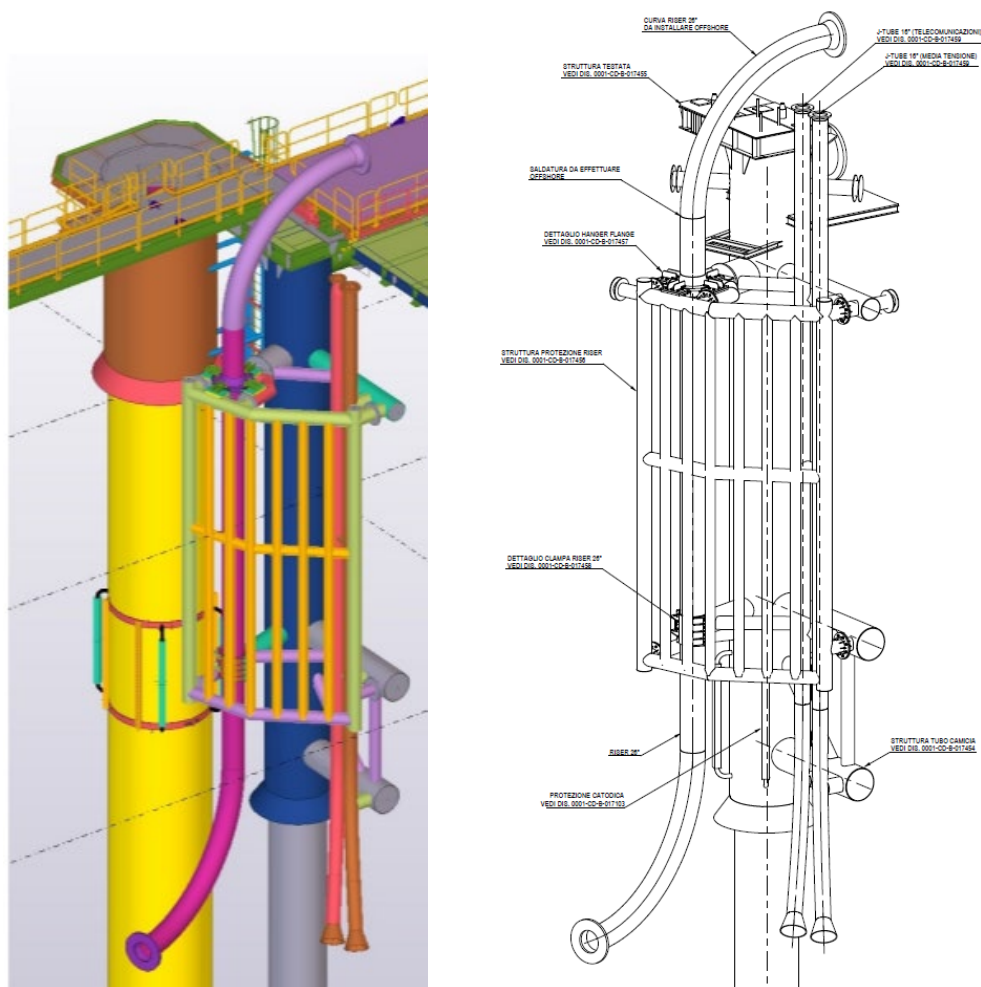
Modello 3D e Geometria Struttura di Supporto Riser e J-Tube
